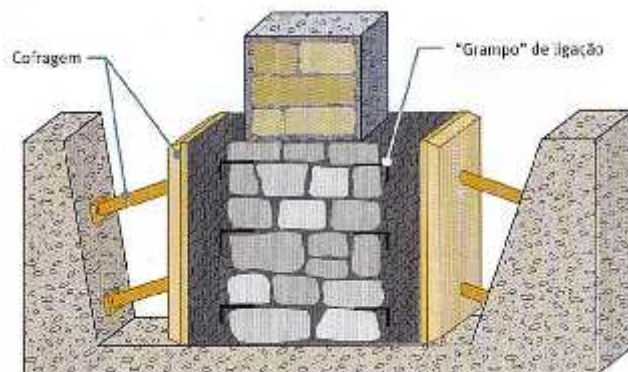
Confinamento e alargamento de fundações [appleton, 2003].
